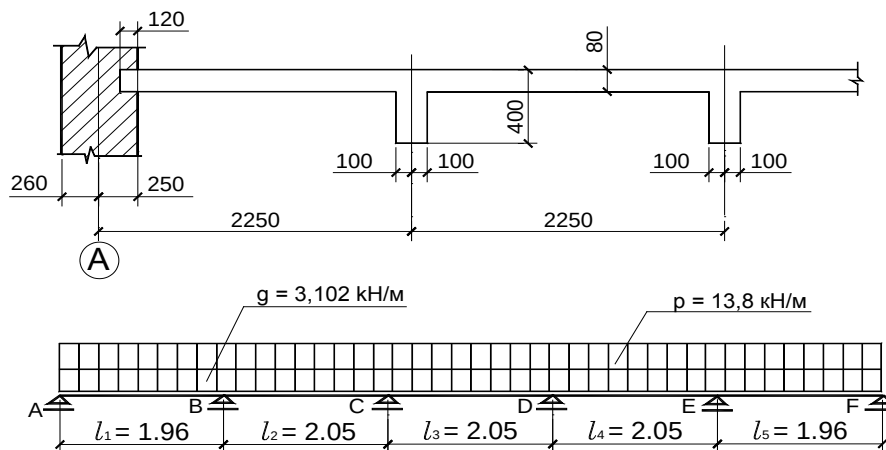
К расчету балочной плиты монолитного перекрытия:
